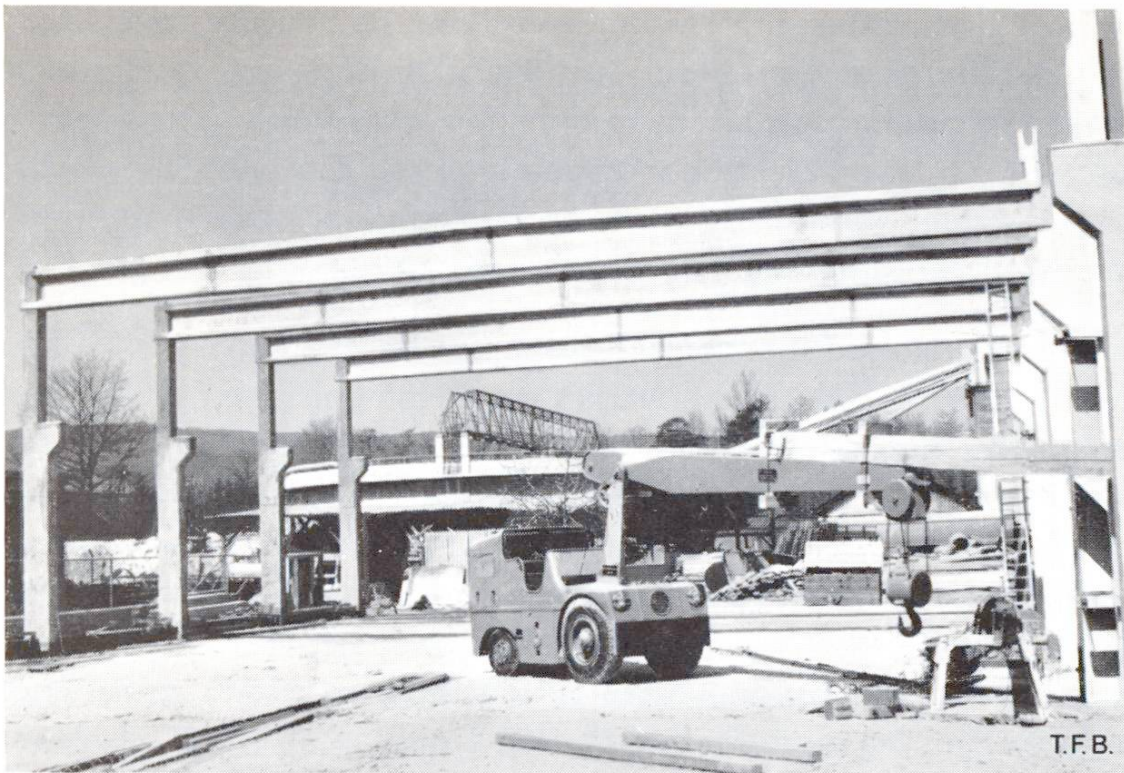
Vorgespannte Dachbinder für Magazinbau. Gewicht 6,8 t, Spannweite 17 m
